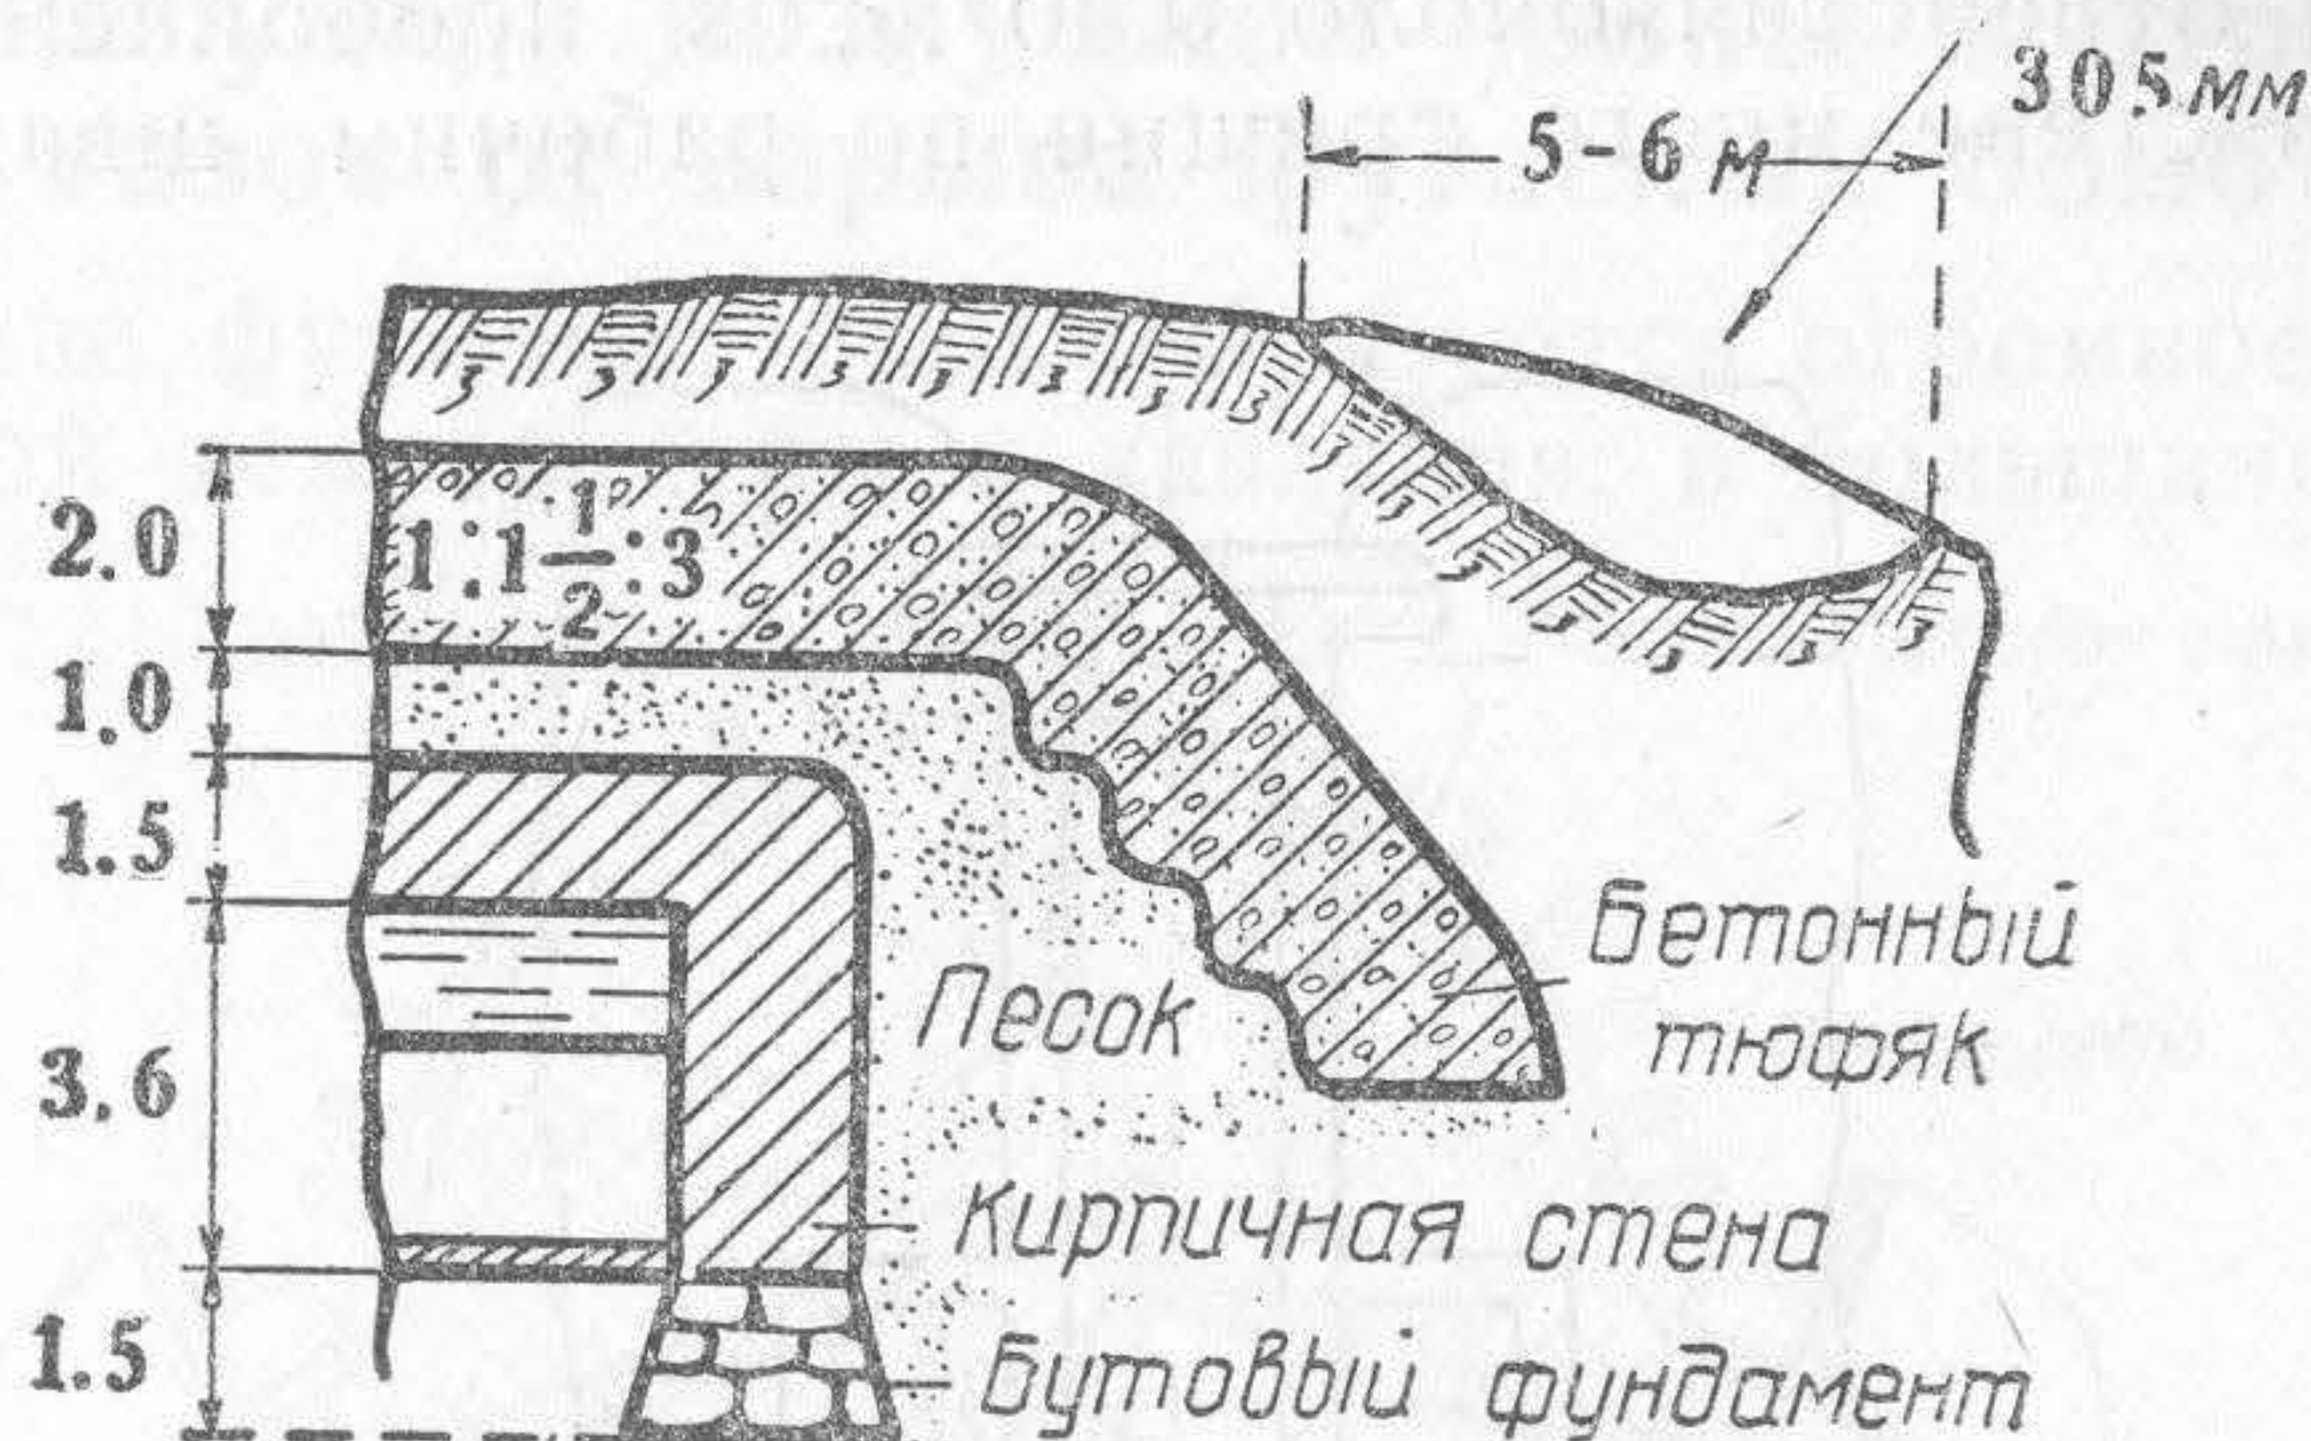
Попадание бомбы в напольную стену бетонного убежища
